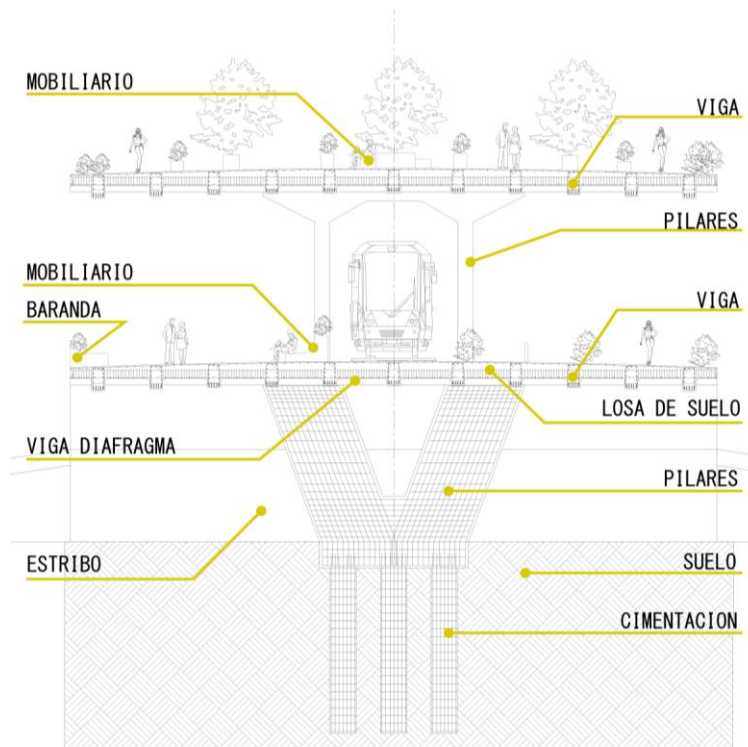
Partes del puente en corte. Elaboración propia, (Ilustrador).
